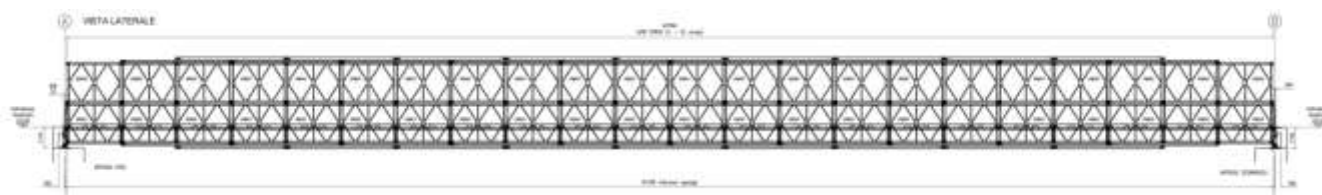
Nuovo prospetto del ponte di attraversamento della Dora.
